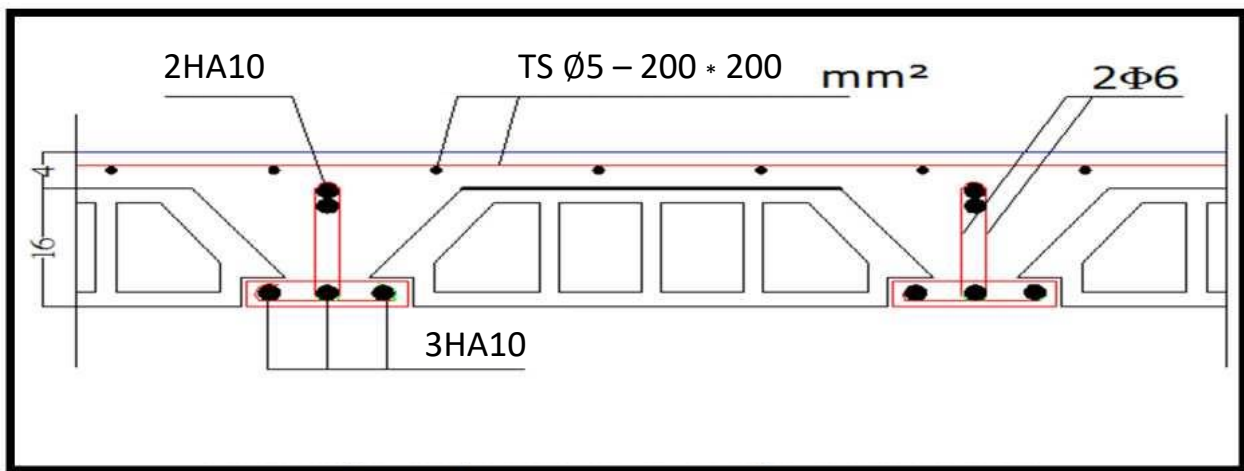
Coupe schématique du ferrailage du plancher.
